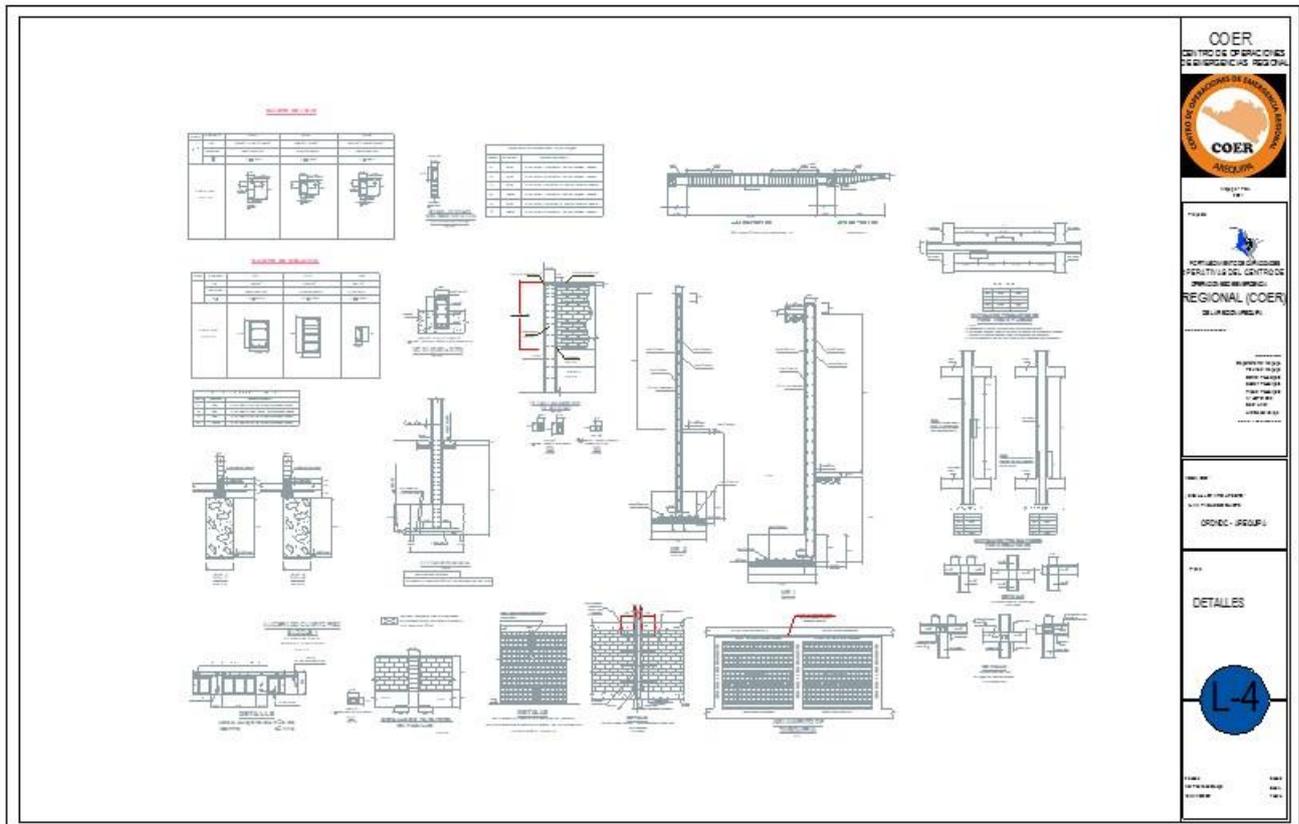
Detalles de cimentaciones, aligerados, vigas, columnas.
